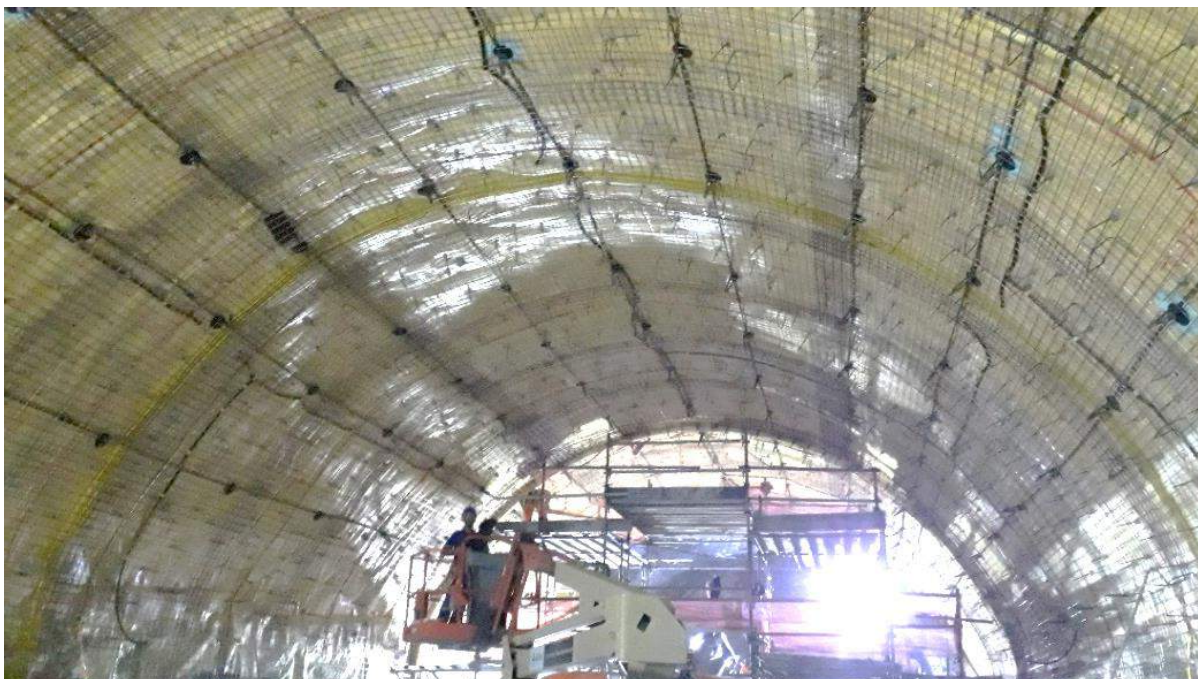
Fixação de telas metálicas aos *trumpets*, auxiliada por pastilhas de concreto; instalação das mangueiras para injeção de calda de cimento (calda de contato)
